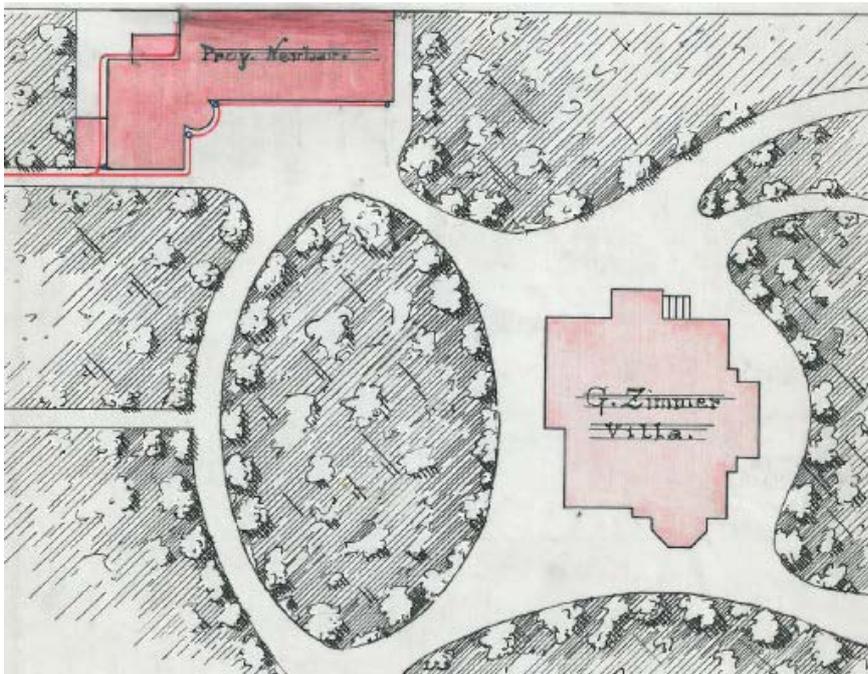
Lageplan von 1891 - damals Handschuhsheimer Landstraße 23 - Quelle Stadt Heidelberg
